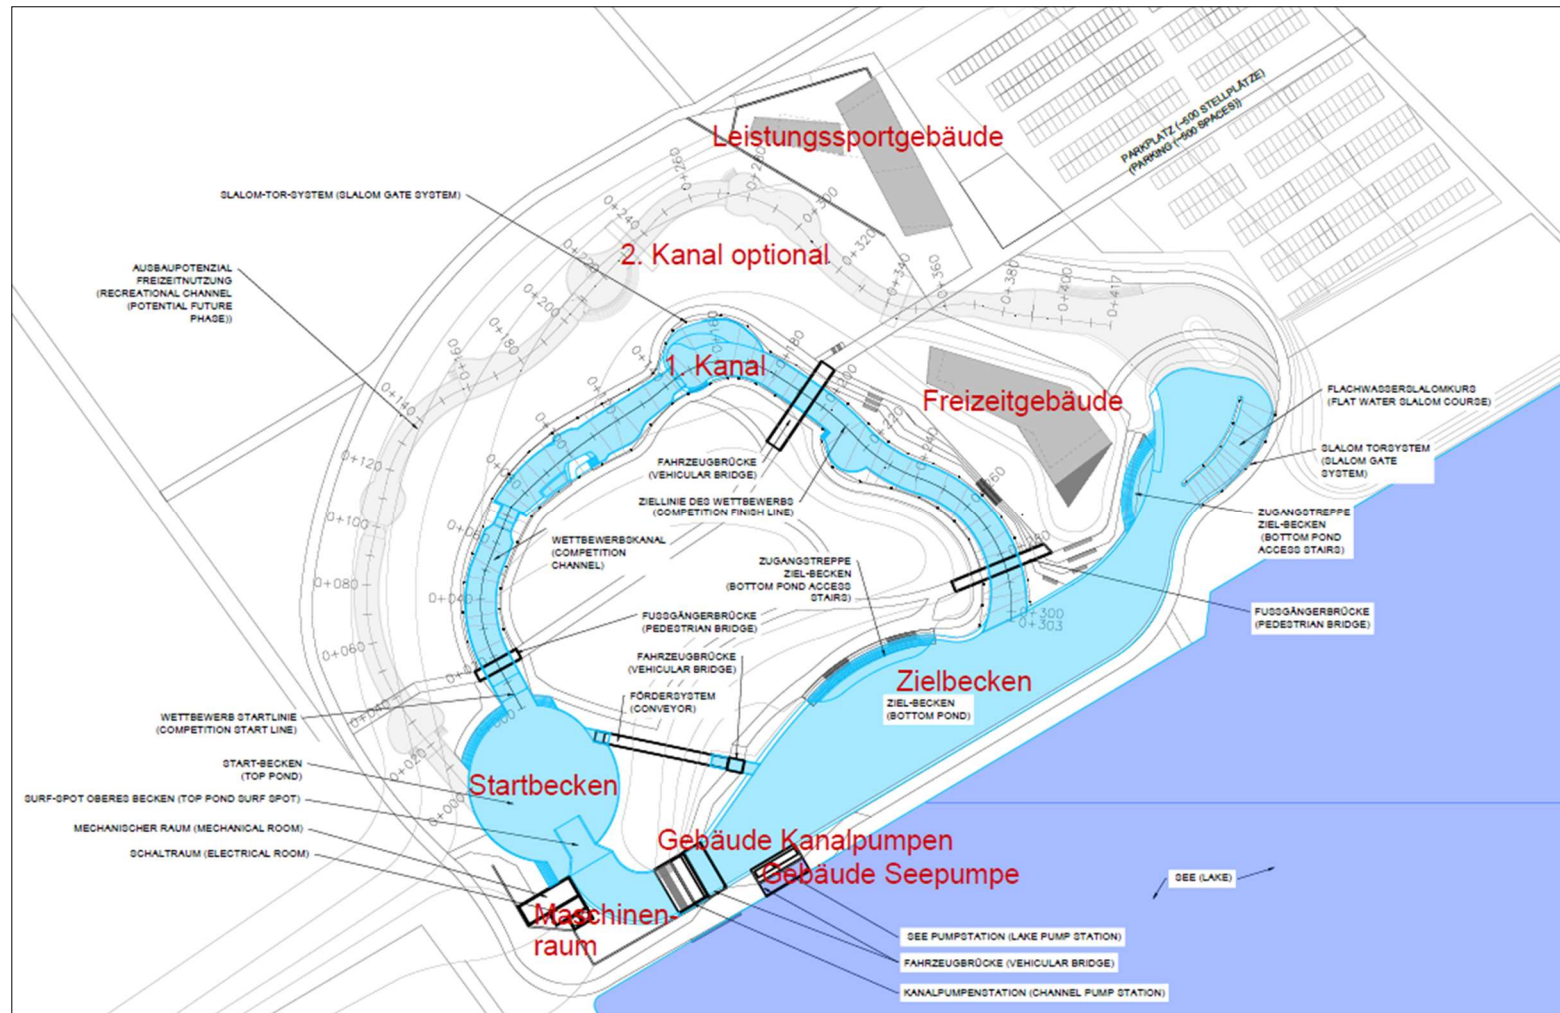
Geplanter Wildwasserpark Dormagen mit Angaben der Gebäude (Quelle: Planungsbüro Fichtner)
